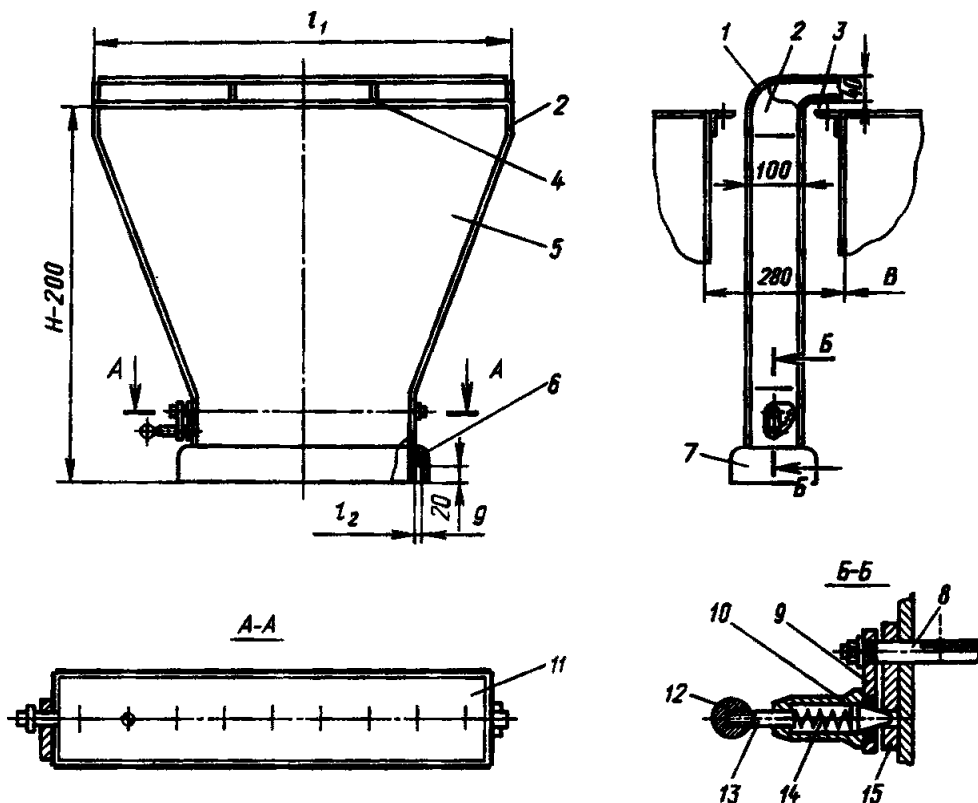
Односторонний бортовой отсос с вертикальной щелью всасывания: H и B — соответственно высота и ширина ванны; l_1 — длина щели бортового отсоса; l_2 — длина соединительного патрубка; 1 — задняя стенка; 2 — боковая стенка; 3 — резиновая прокладка; 4 — распорка; 5 — передняя стенка; 6 — прокладка; 7 — гнутые планки; 8 — ось; 9 — планка; 10 — втулка; 11 — шибер; 12 — ручка; 13 — фиксатор; 14 — пружина; 15 — планка.
